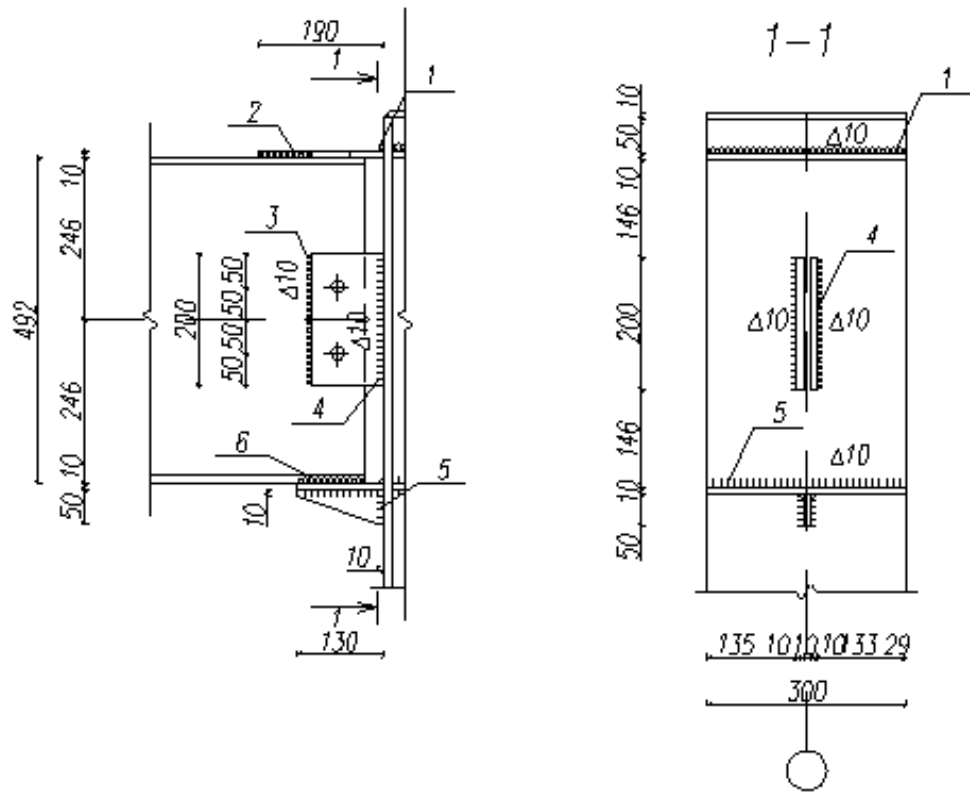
Схема кріплення ригеля до колони, вузол 3.
